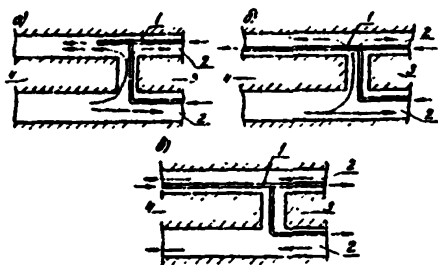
Схемы вентиляции параллельных выработок с использованием сбоек:
